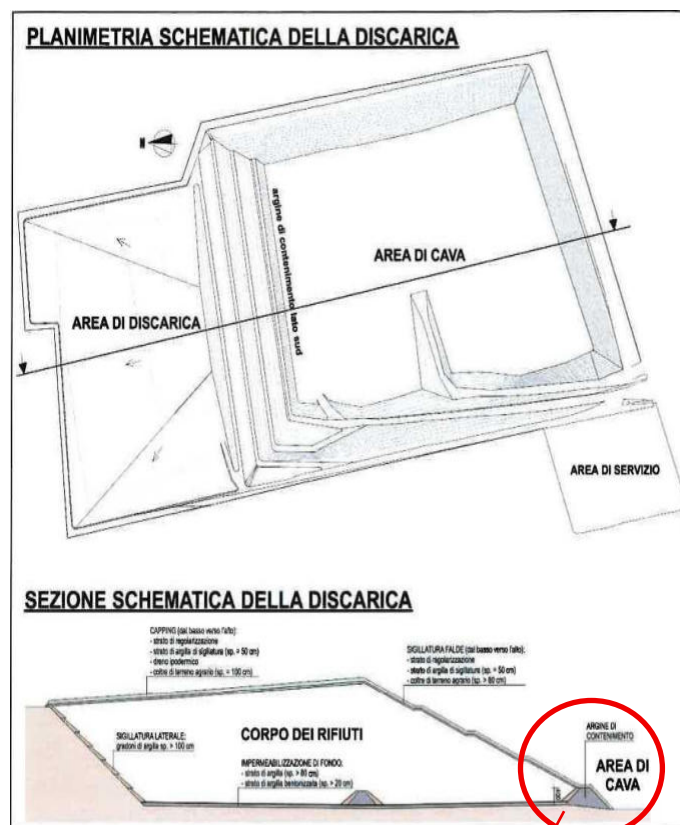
Sezione schematica della discarica finale, ricavata dagli elaborati di progetto
